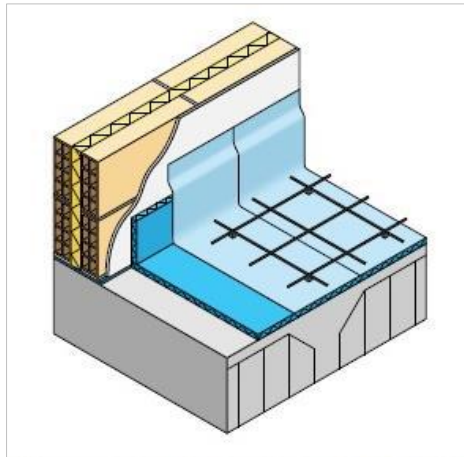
Colocación de la barrera impermeable sobre la capa anti-impacto
